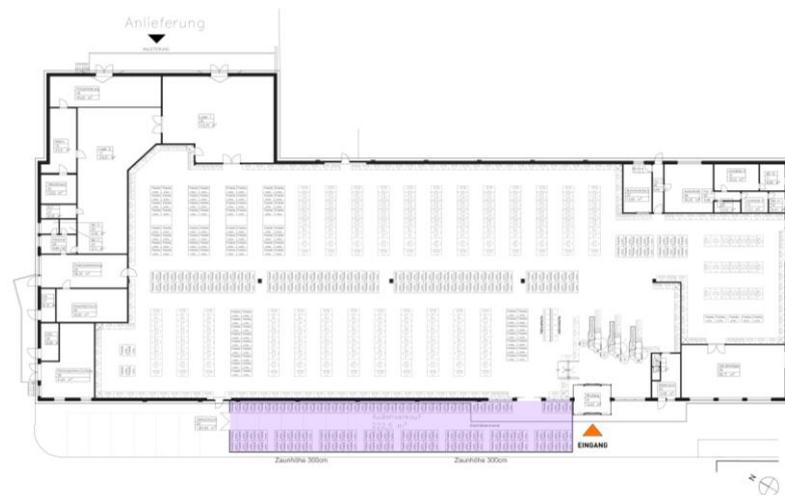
Grundriss (Morese Architekten, Stand 08/22)
